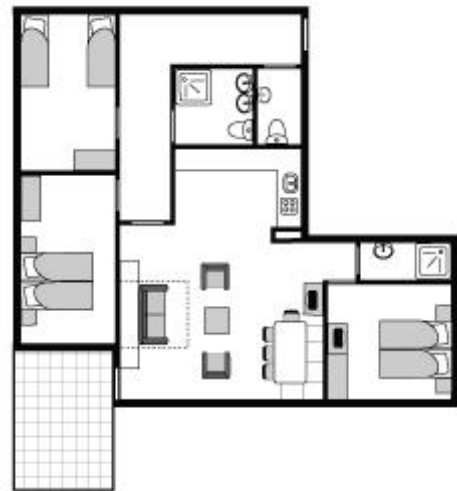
Wohnungsgrundriss einer Ferienwohnung (Quelle: Landal GreenParks GmbH 2014)
